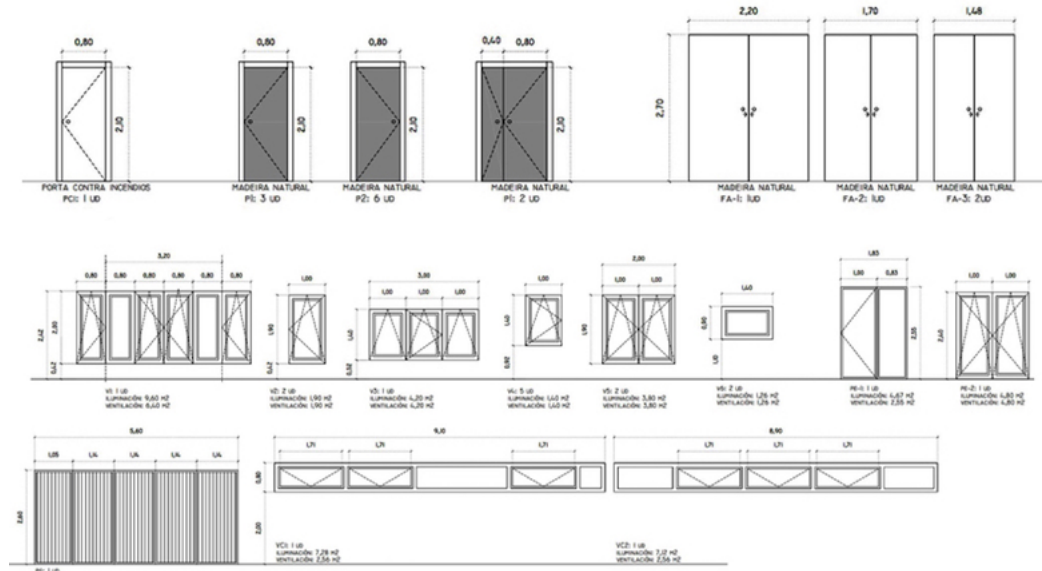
Ejemplo de planos de puertas y ventanas (Fuente: Planos técnicos (2018))
